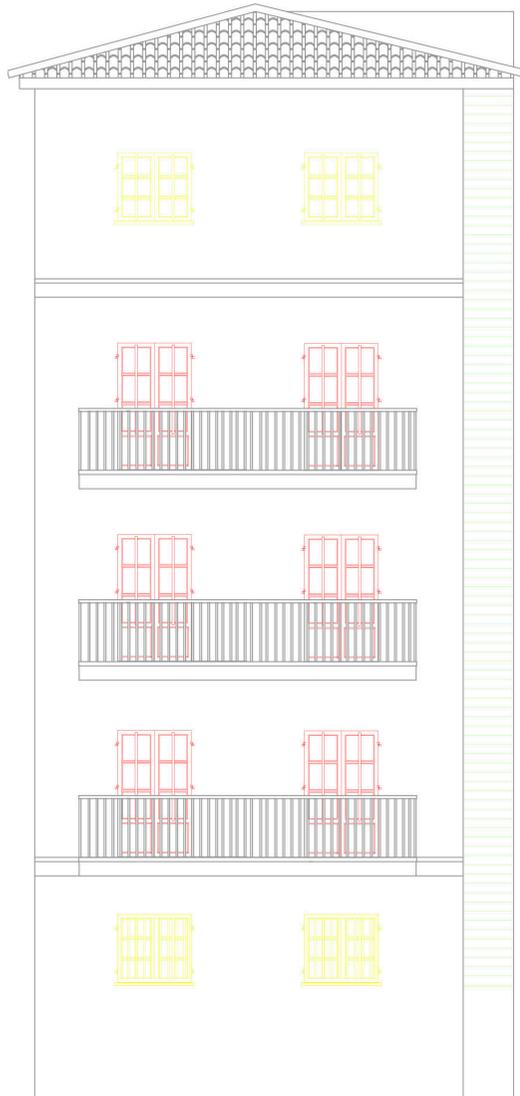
Alzado fachada lateral oeste, caracterización de huecos. Fuente: Elaboración propia.
